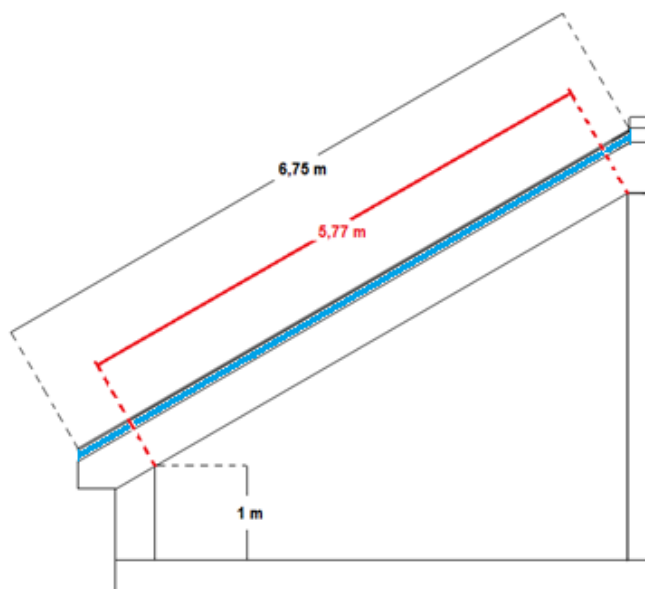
A.8. Sezione trasversale, rispetto alla linea di colmo, di una zona del sottotetto
